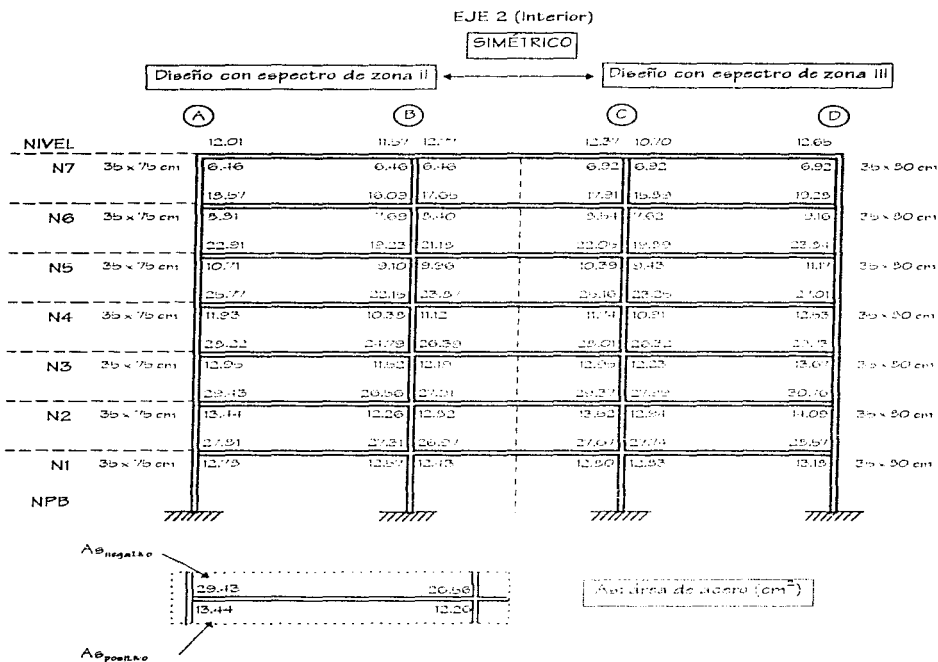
Comparación de cuantías de acero de refuerzo longitudinal de las vigas del eje 2 de las estructuras diseñadas en las zonas II y III
